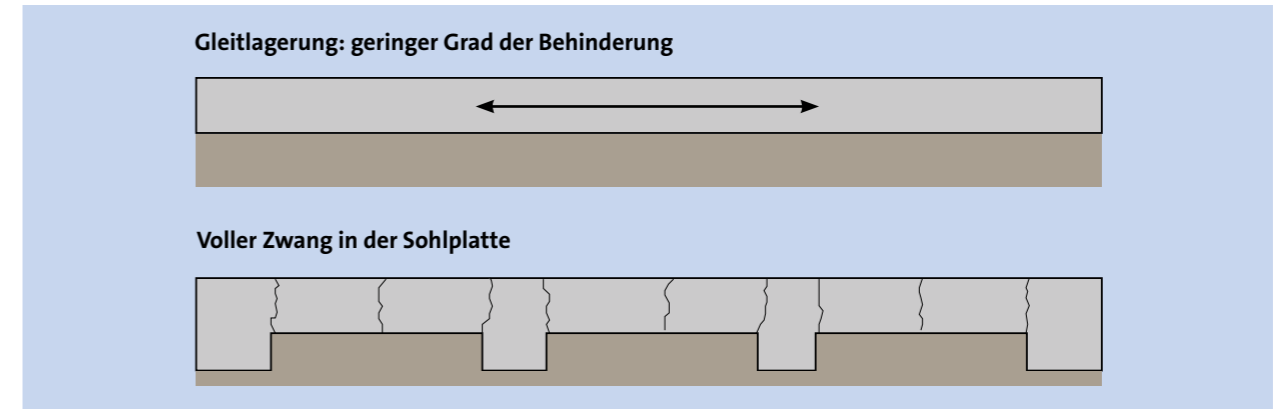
Gleitlagerung der Bodenplatte - voller Zwang verursacht Risse
